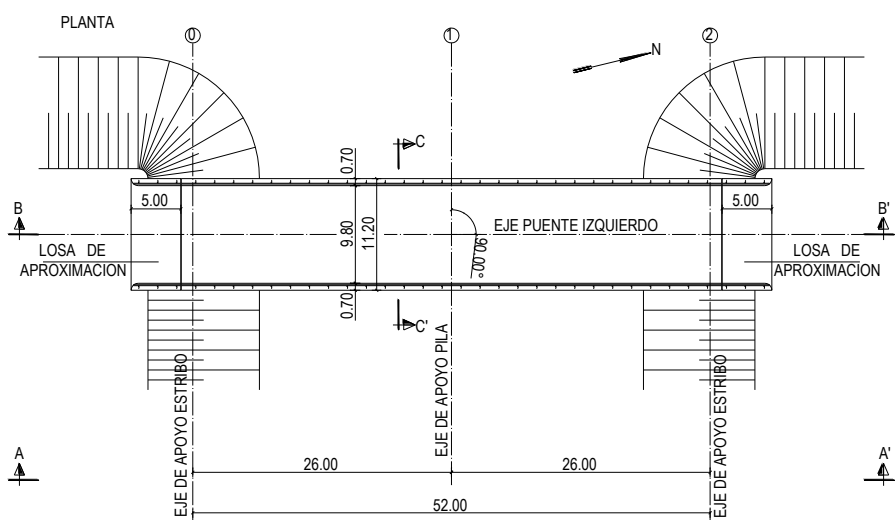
Planta del puente izquierdo ubicado sobre Avenida Gobernador del Campo (P3).
